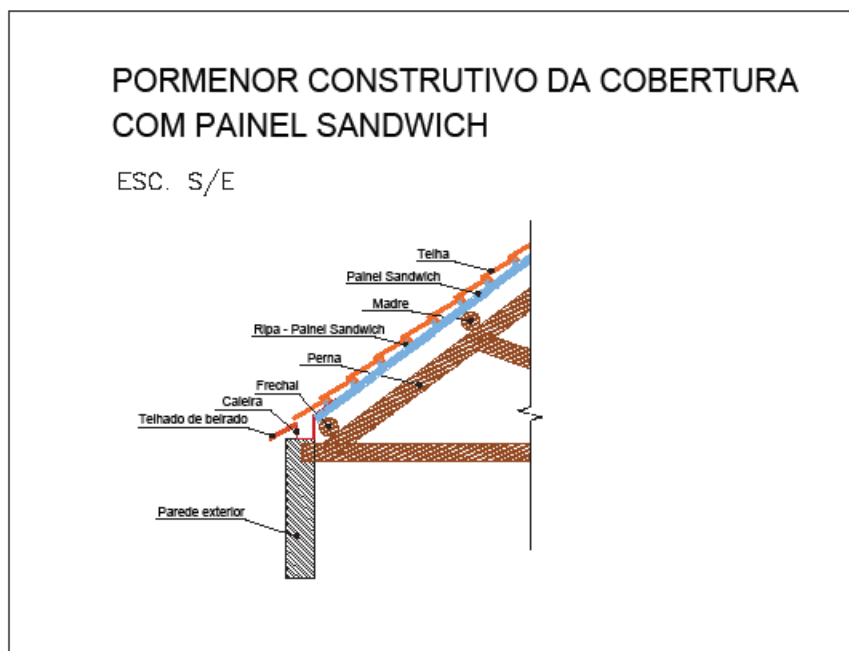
Pormenor da cobertura com painel sandwich (depois)
